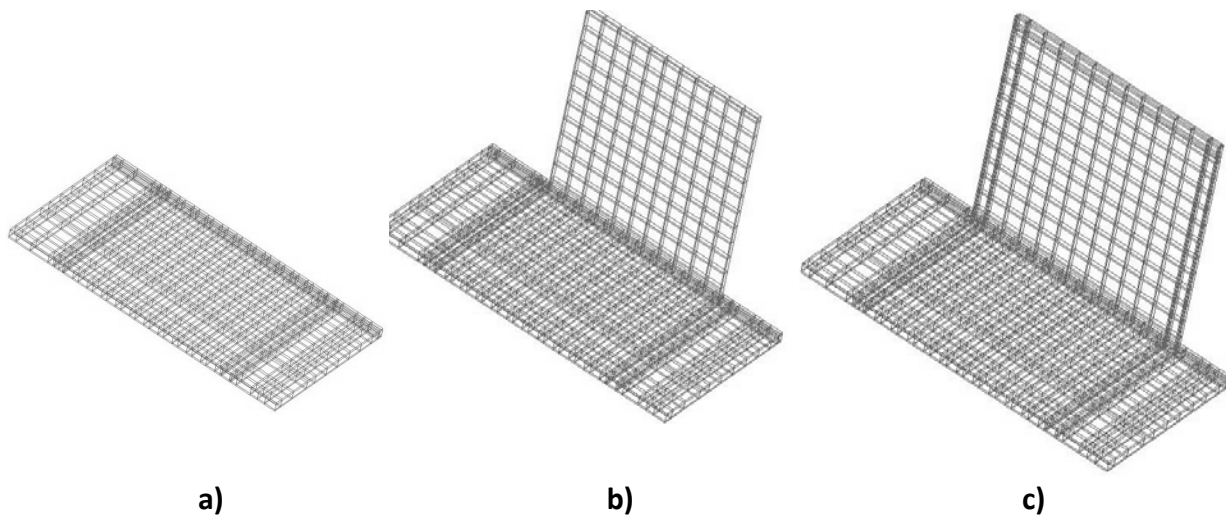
Ensamble de mallado de los elementos de concreto a) Losa b) Losa-muro c) Losa-muro-castillos-dala
